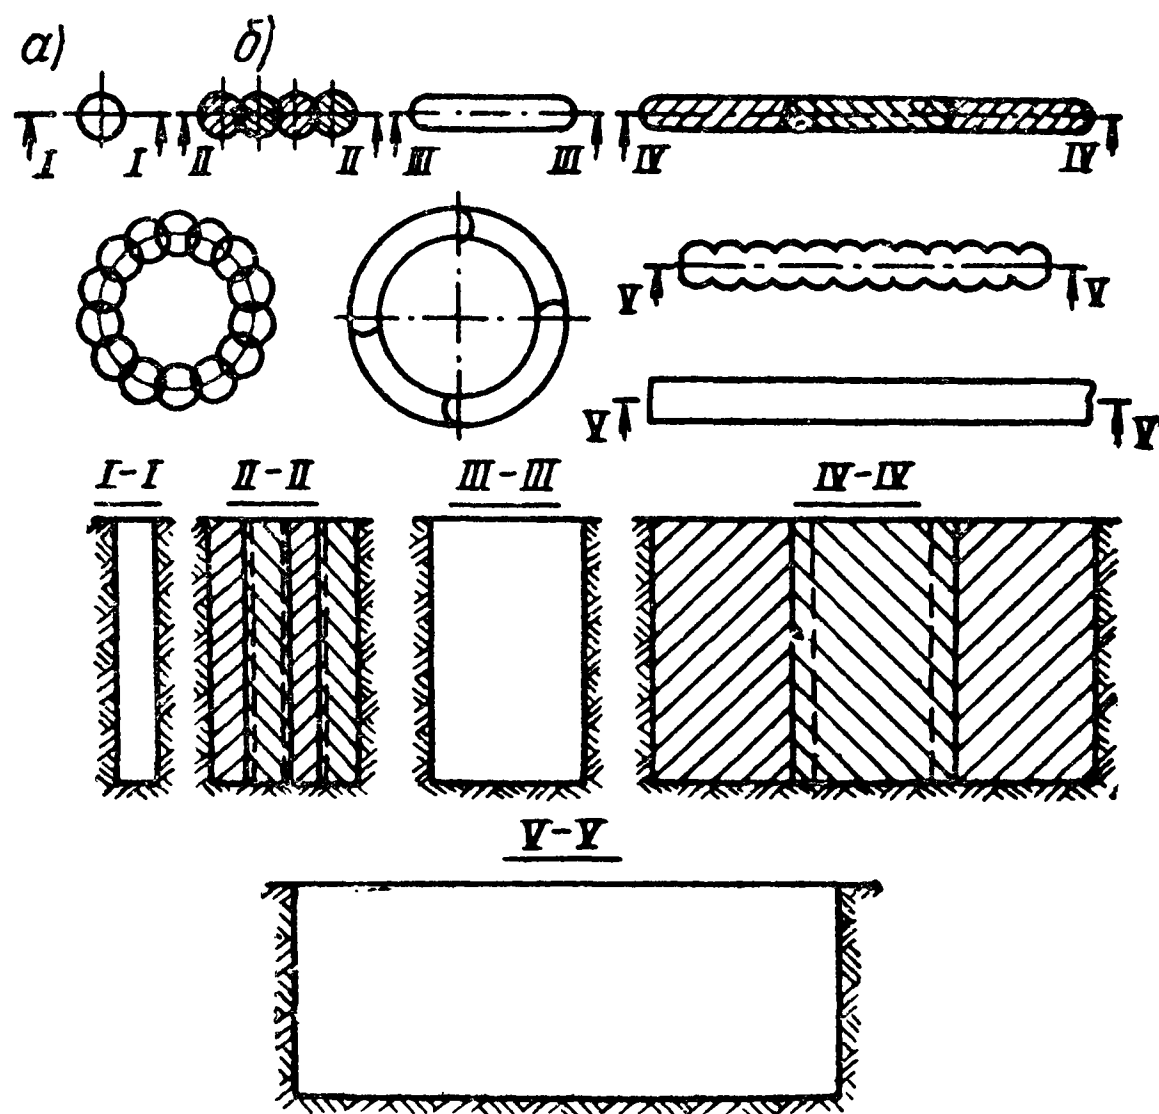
Конструкция бетоно-свайных и траншейных противодиффузионных завес
